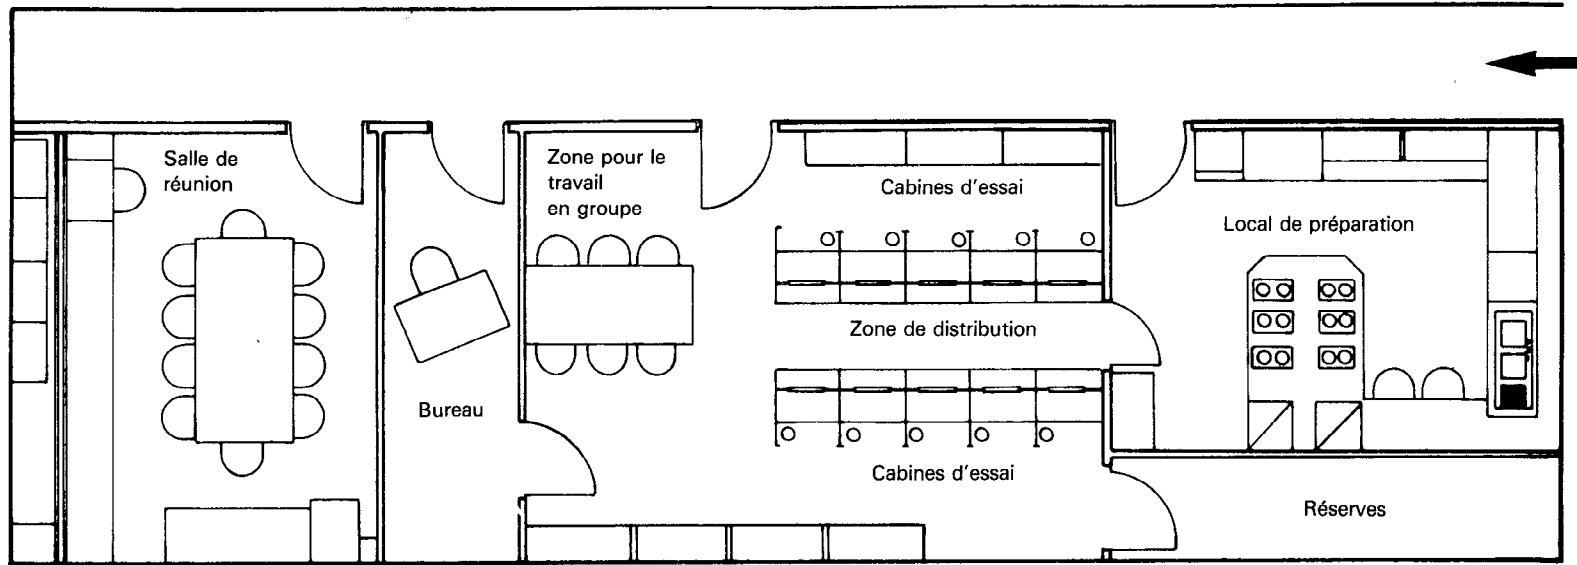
Exemple de plan de locaux destinés à l'analyse sensorielle
